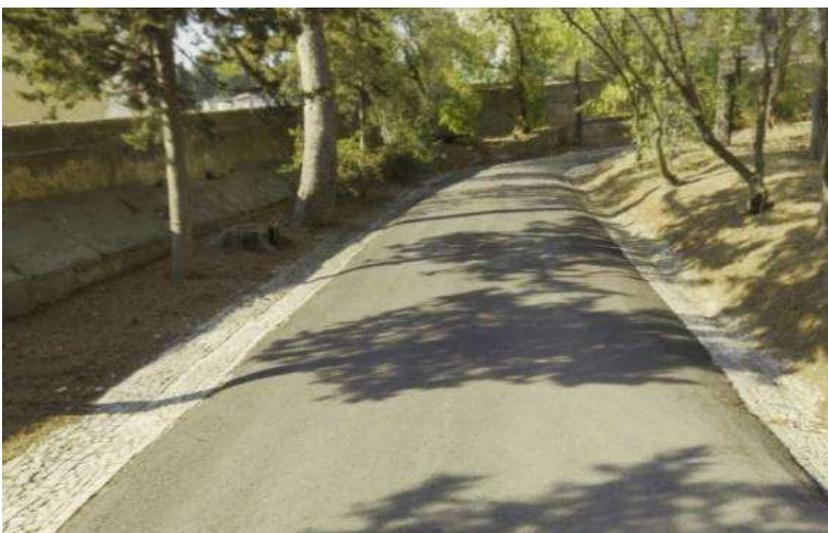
Pavimento em camada de desgaste em betuminoso.
